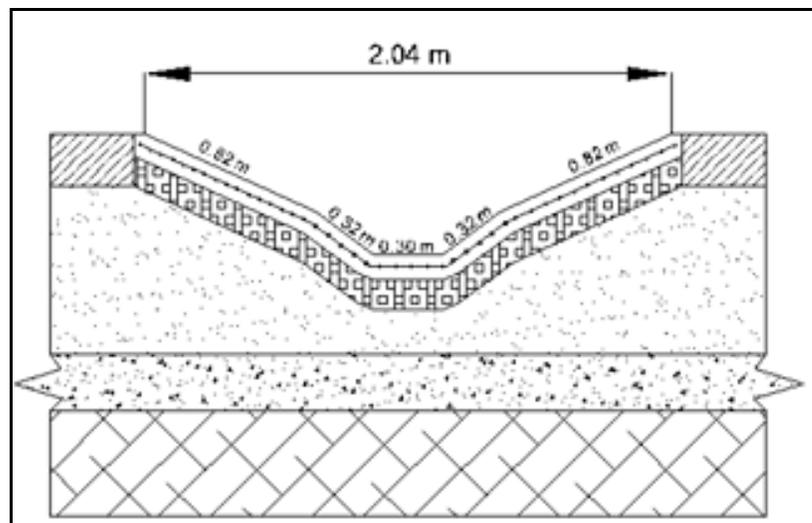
Canal de sección trapezoidal en el área de estudio.
